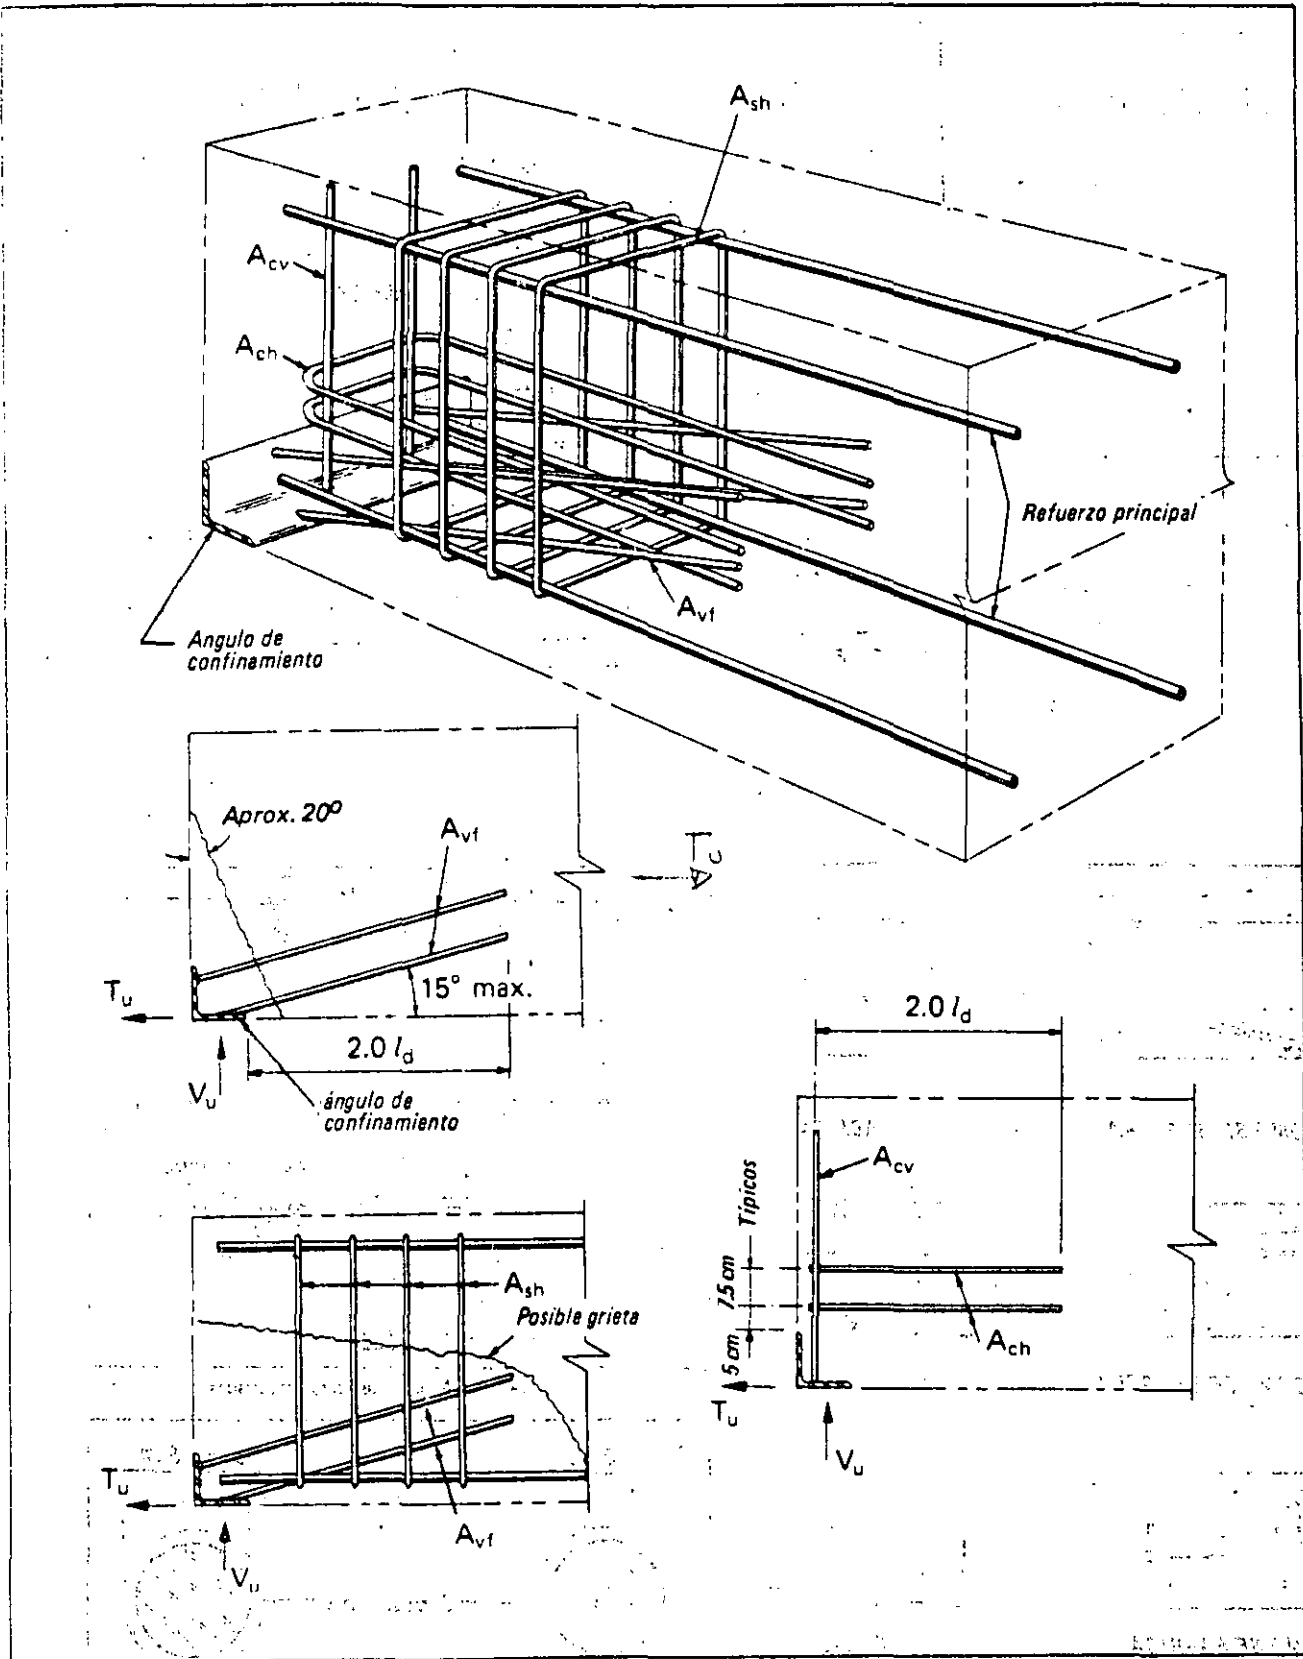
Condiciones del apoyo en concreto confinado
